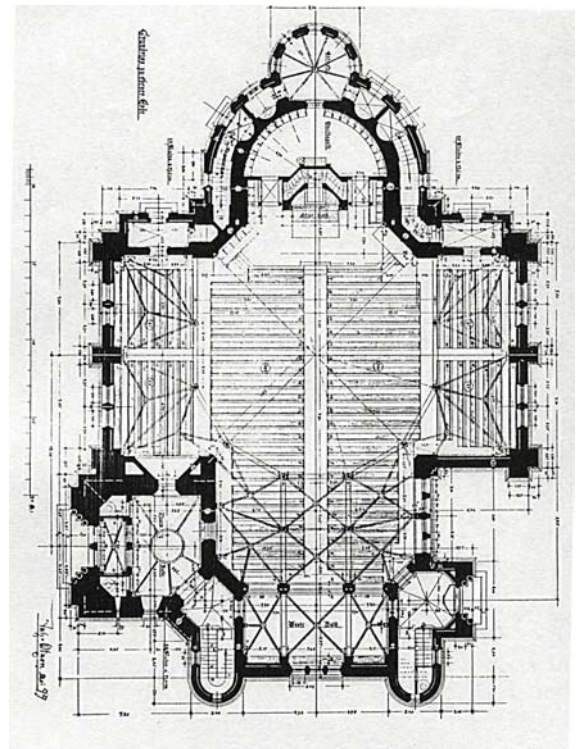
Grundriss Erdgeschoss, Johannes Otzen, Mai 1899
